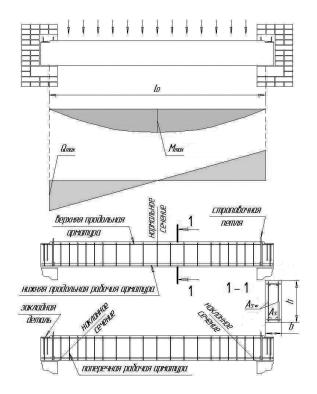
Работа железобетонной балки перекрытия под действием равномерно распределенной нагрузки. Расчетная схема, усилия и армирование железобетонной балки
